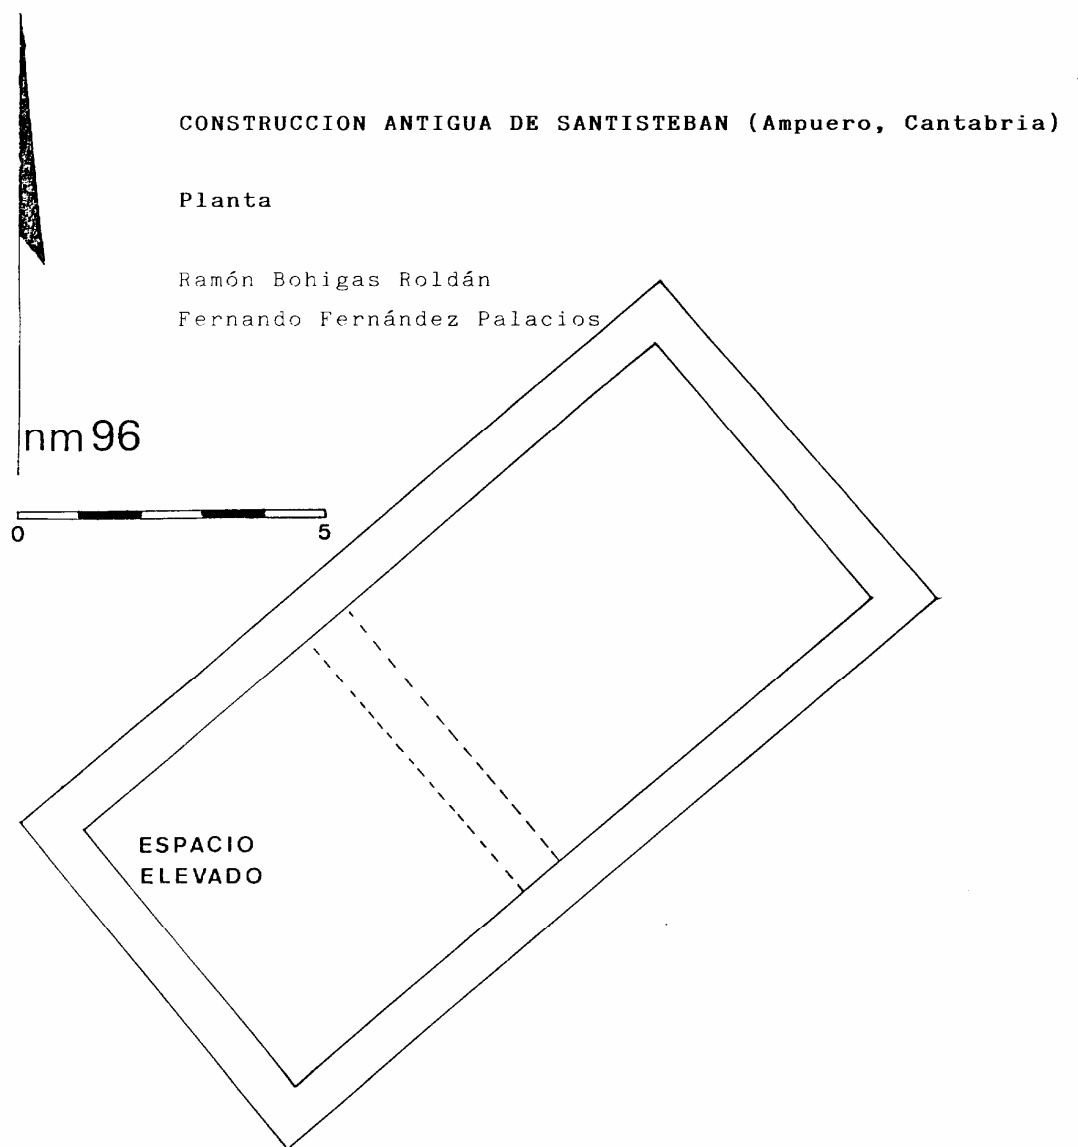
planta de la construcción antigua de Santisteban (Ampuero).
